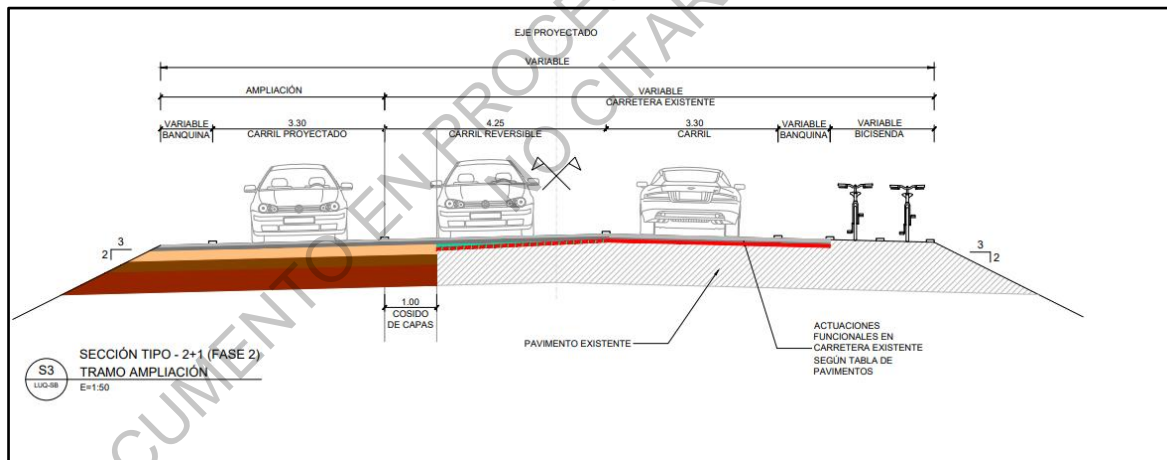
Sección tipo – Tramo 14 con Carril reversible
